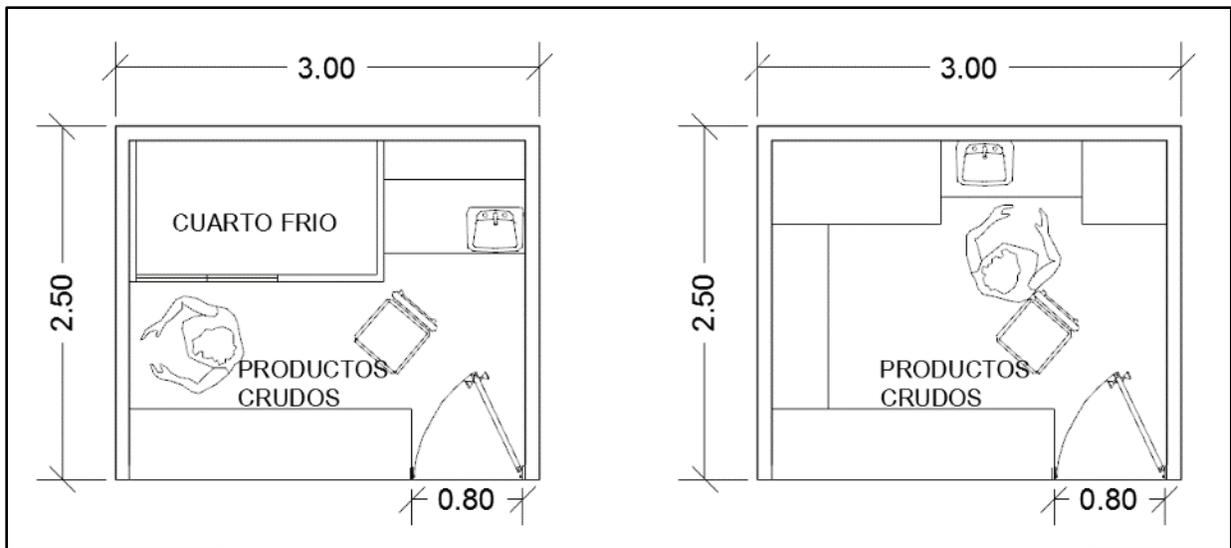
propuesta distribución en planta PRODUCTOS CRUDOS SIN ESCALA
